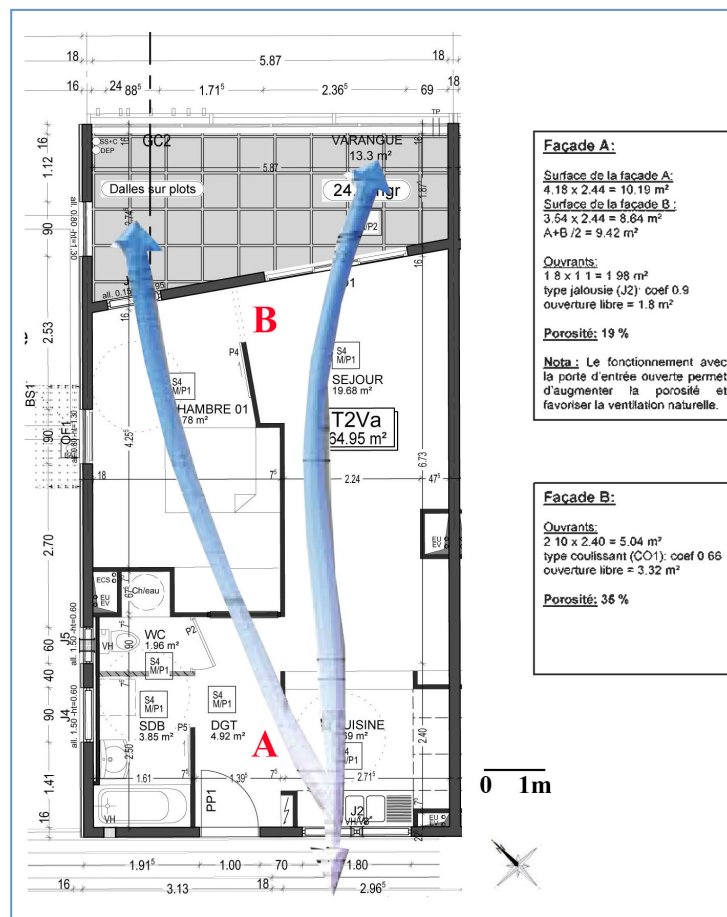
Florès et Malacca, Plan T2Va, Bâtiment Florès, Ventilation traversante [Agence 2APMR]
